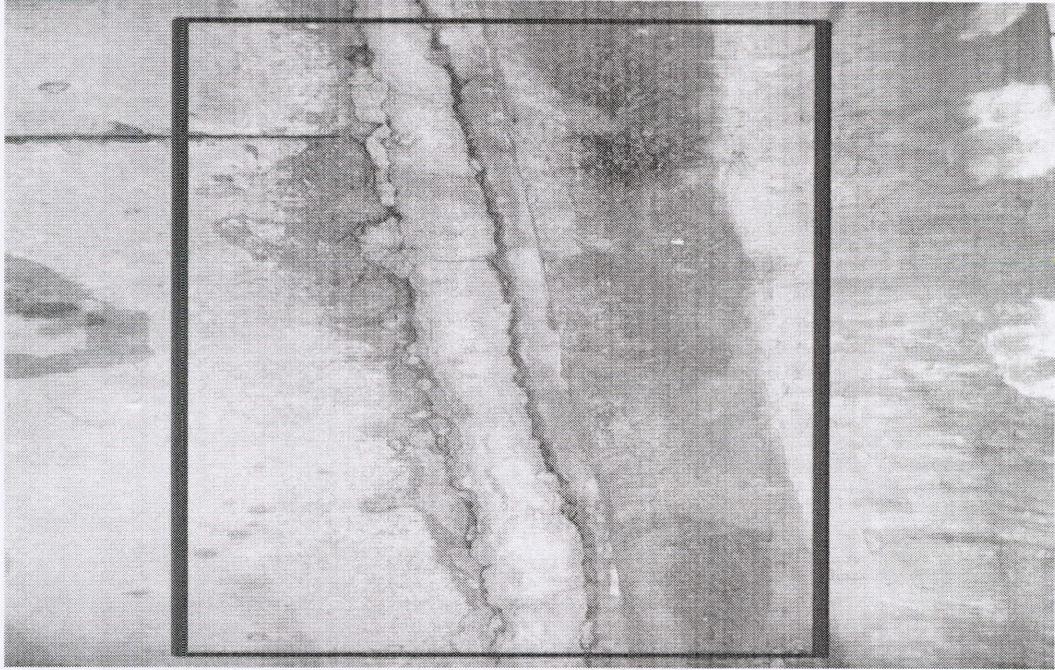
屋面防水层混凝土保护层存在较多条纵、横向裂缝，以及排水沟边部混凝土破碎和裂缝没有处理
